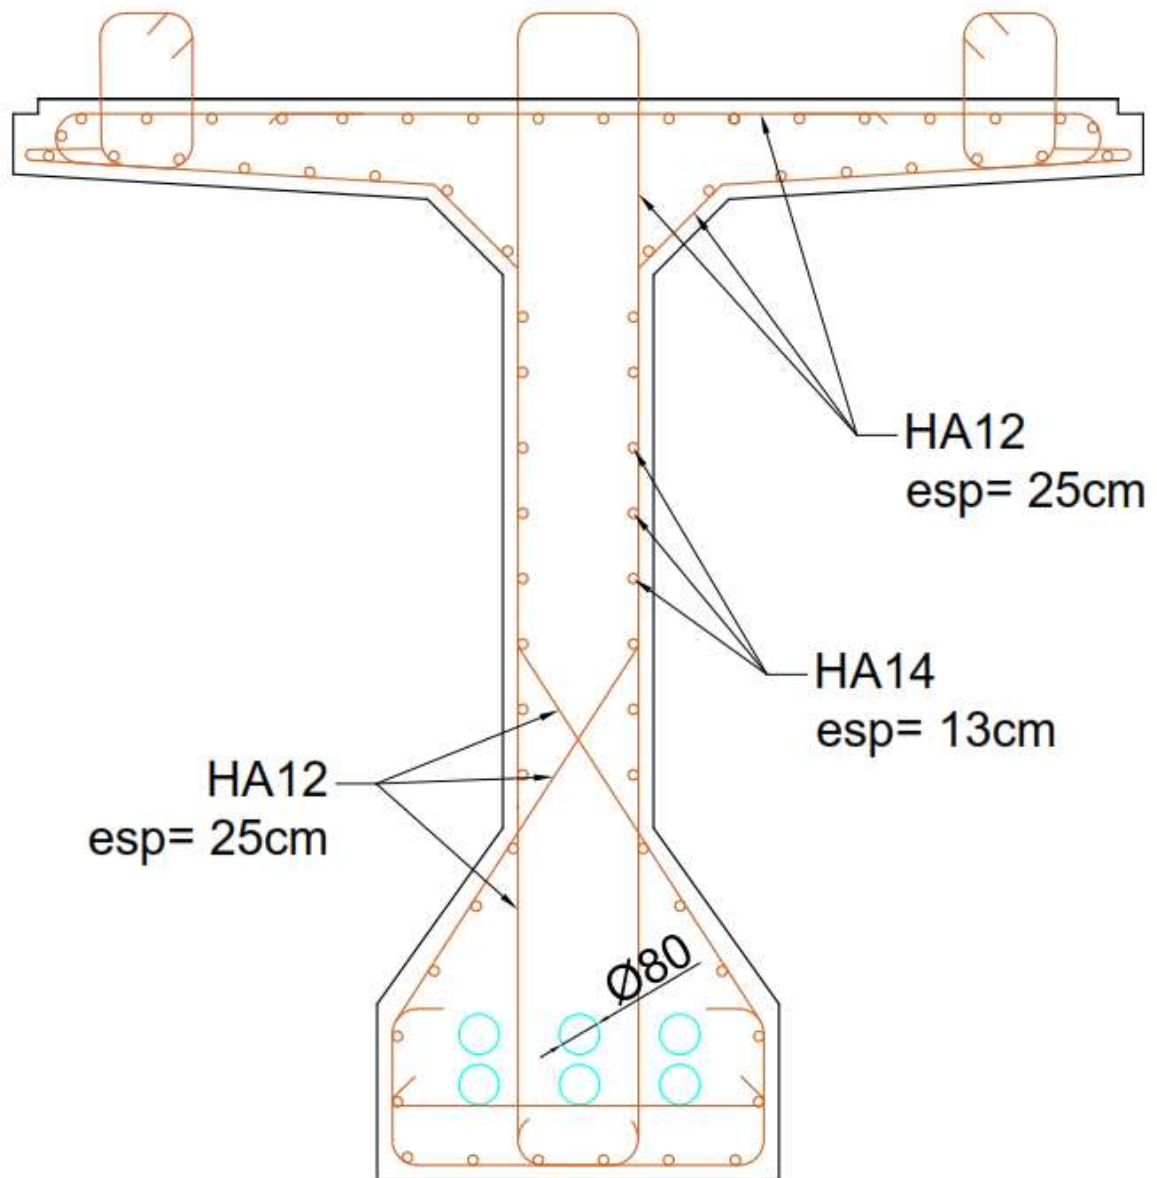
ferrailage de la poutre précontrainte en section médiane
